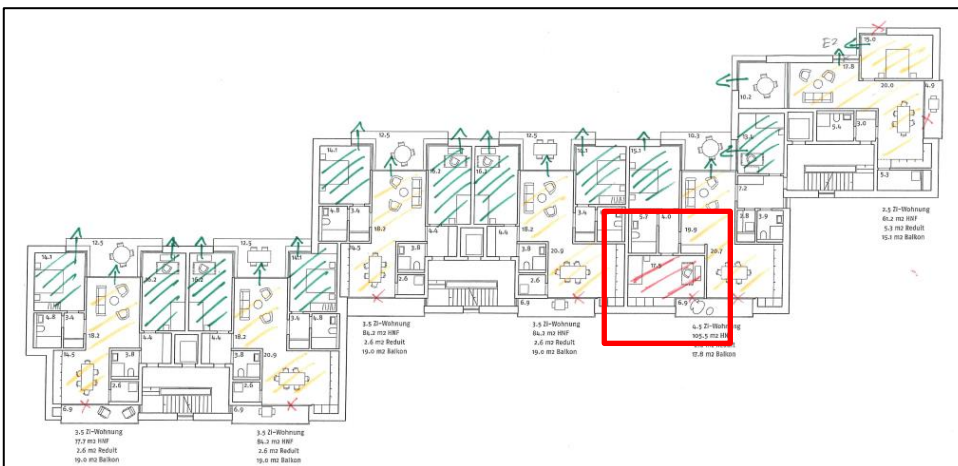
Grundriss Regelgeschoss Stand 09.2020, eingefärbt gemäss Ampelsystem
